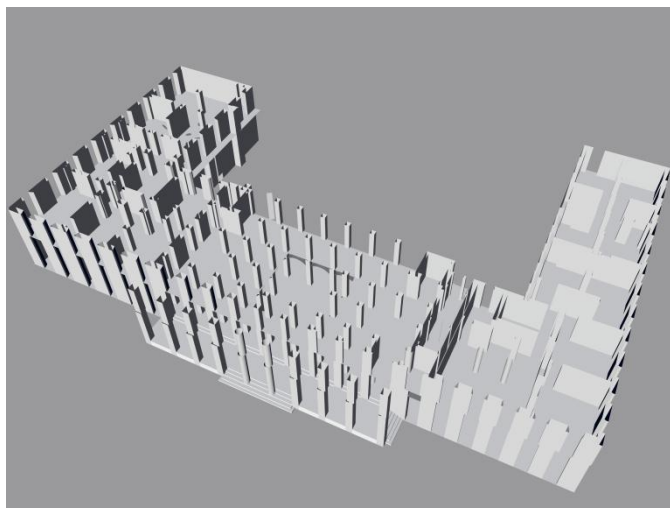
Vista tridimensionale della maglia strutturale di pilastri
